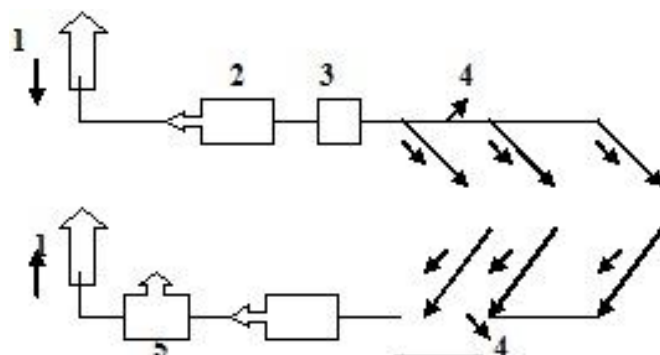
Схема приточно-вытяжной системы вентиляции.
